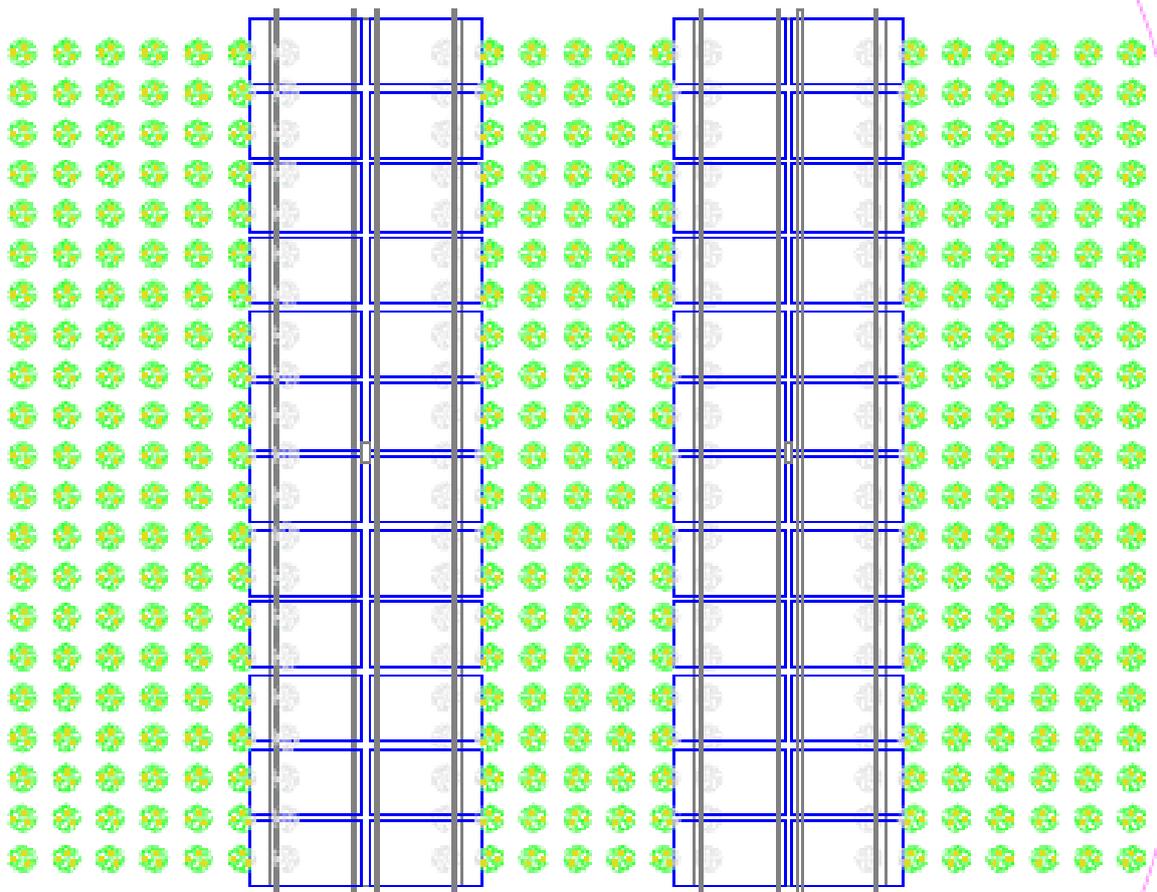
Piantumazione tra le file di tracker (vista dall'alto)
